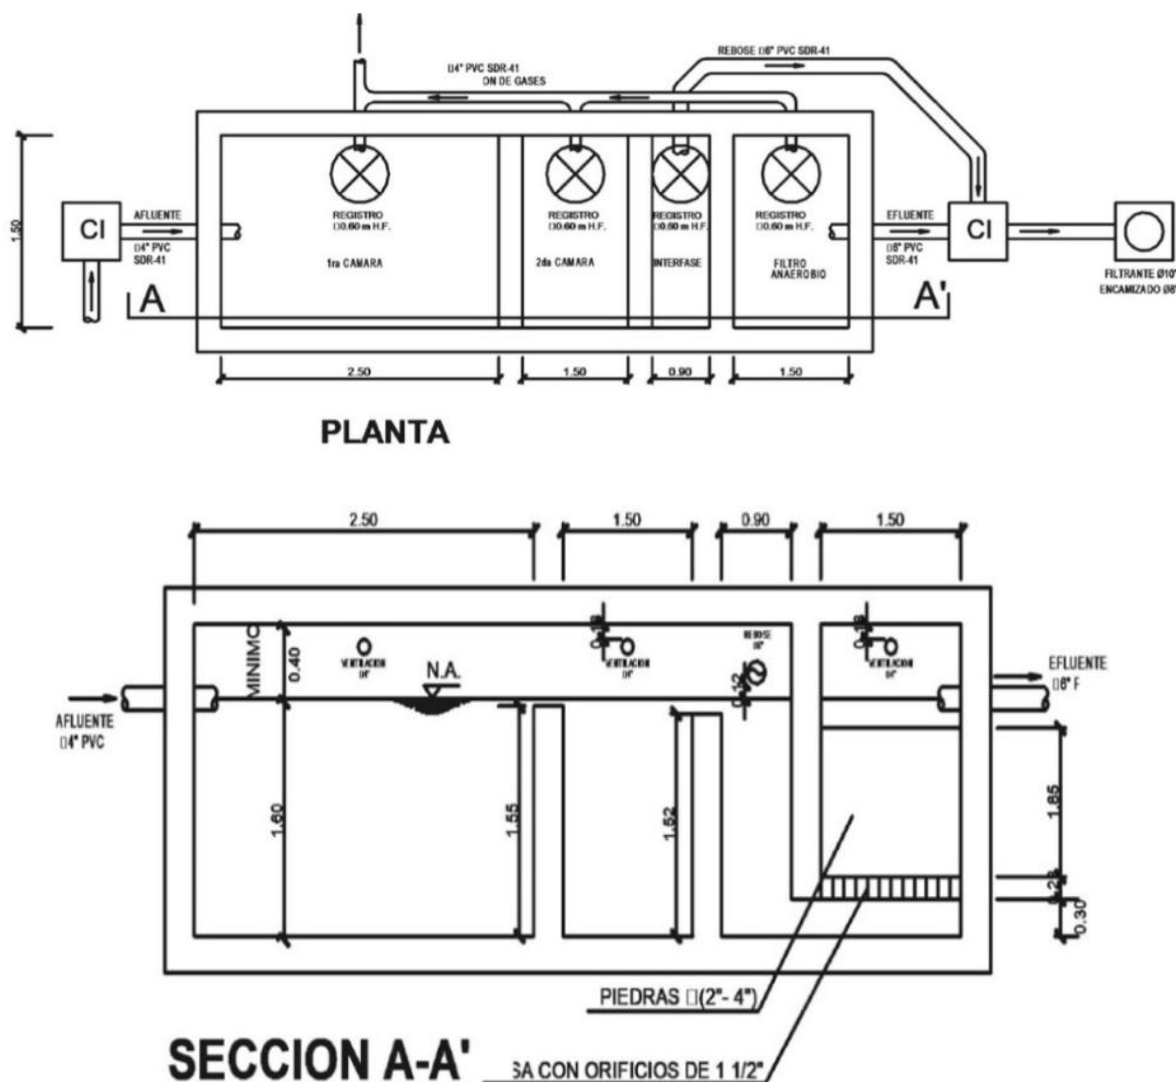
Vista en planta y elevación del sistema de tratamiento
